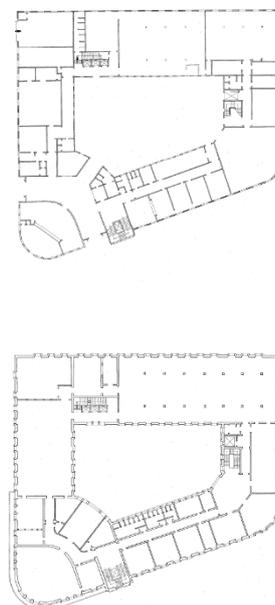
Plantas RC e Piso 1 (originais). Fonte: Arquivos dos CTT e do Forte de Sacavém
